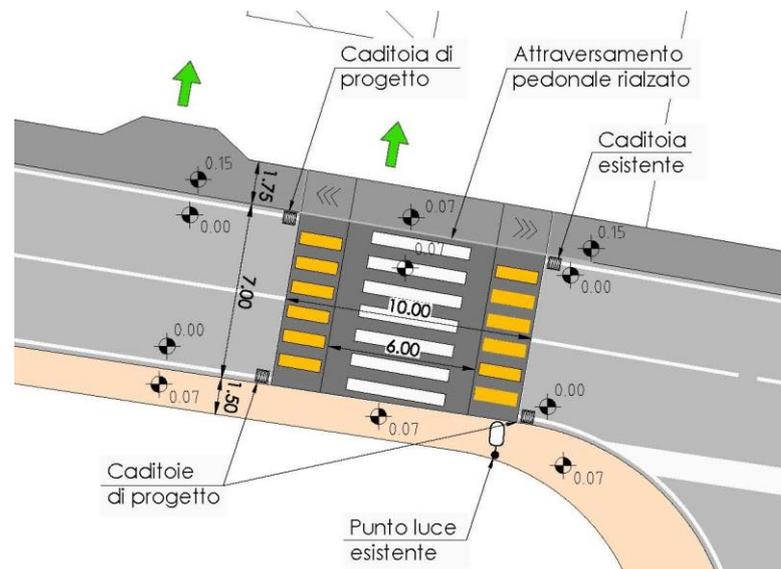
planimetria progetto attraversamento pedonale rialzato
